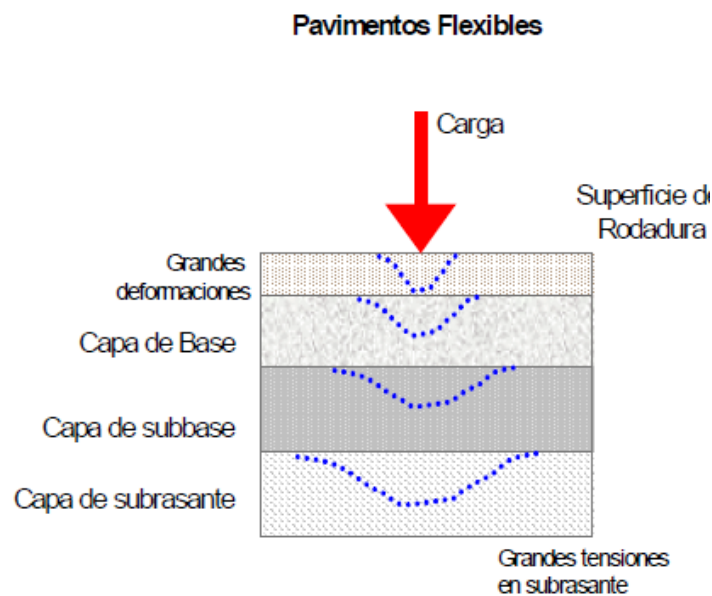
Comportamiento del Pavimento Flexible ante las cargas
